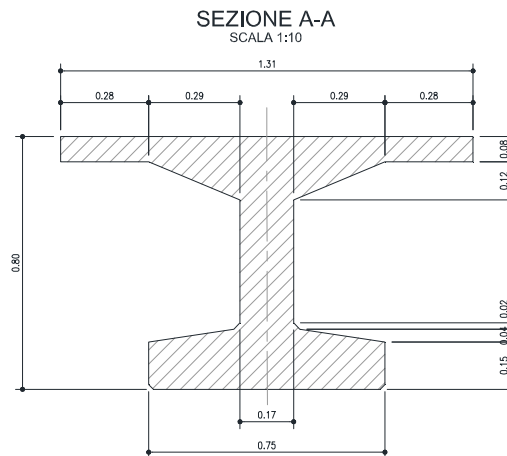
Impalcato Barbavara – Sezione tipica trave
